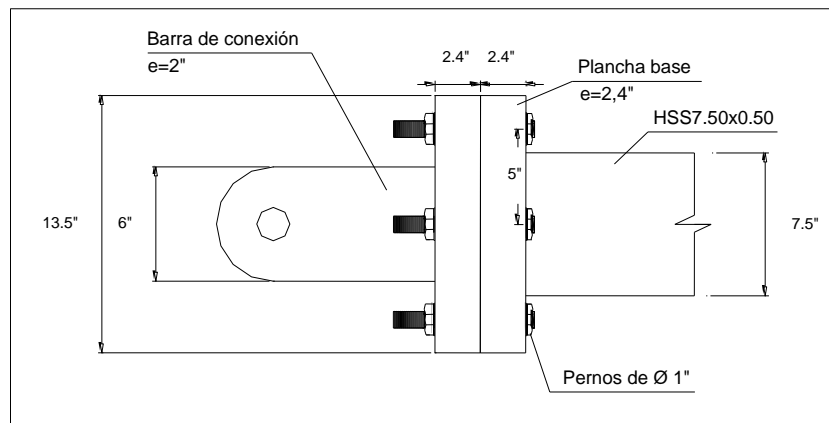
Detalle 2: Conexión Brazo metálico (HSS 7.50x0.50) – Barra de conexión.
